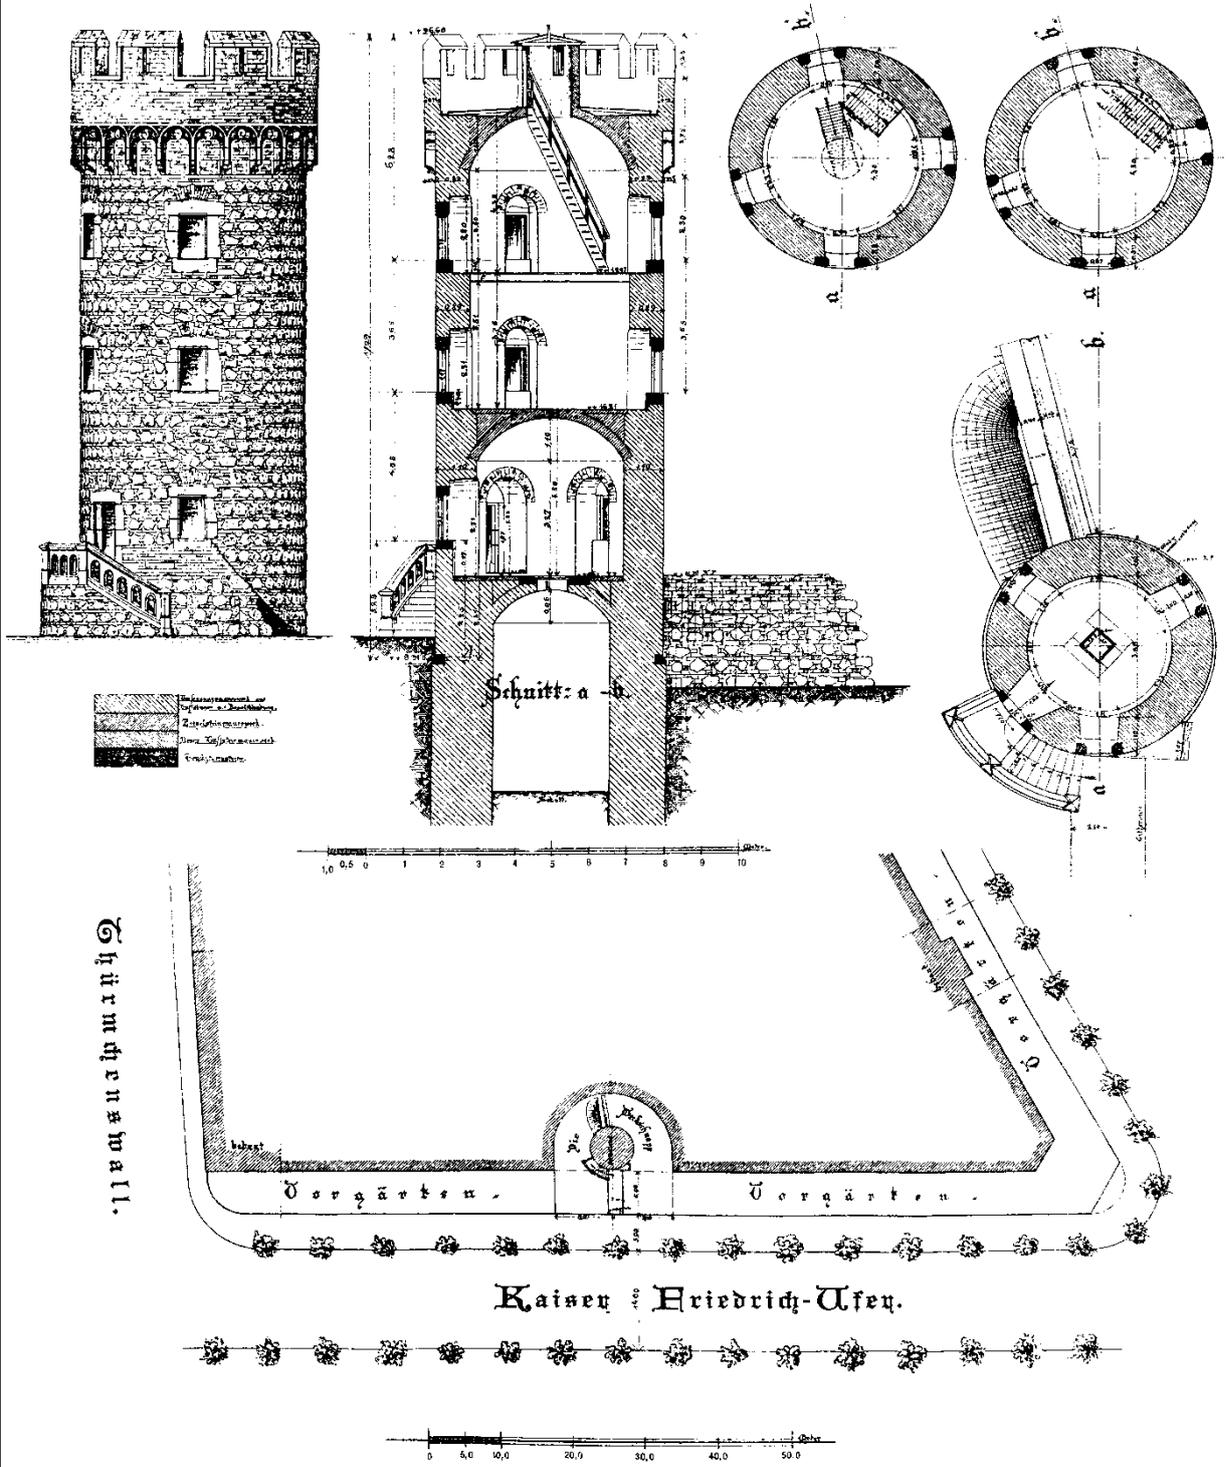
Ansicht, Schnitt, Grundrisse und Lageplan des Kunibertstürmchens („Weckschnapp“) nach der Wiederherstellung im Jahre 1898.
